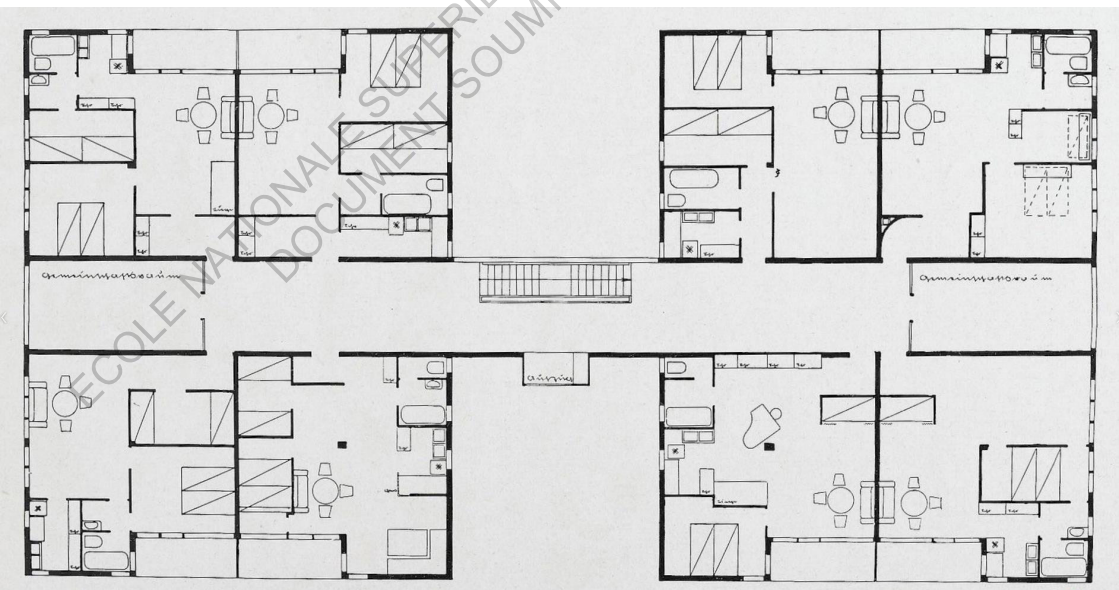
Plan d'étage du Kollektivhaus d'Adolf Rading, bâtiment n°7
